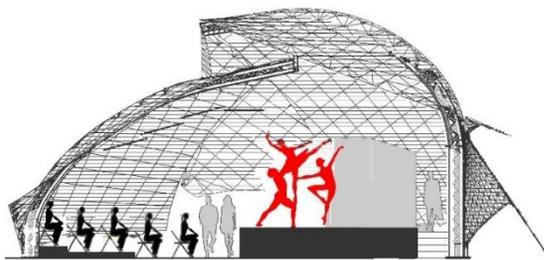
Esquema en planta espacio requerido para danza aplicado al módulo 1. (Peralta J, 2013)
